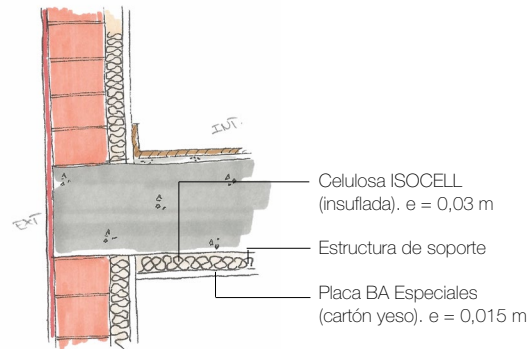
Encuentro forjado con cerramiento con sistema de aislamiento bajo el forjado (autoría propia).
